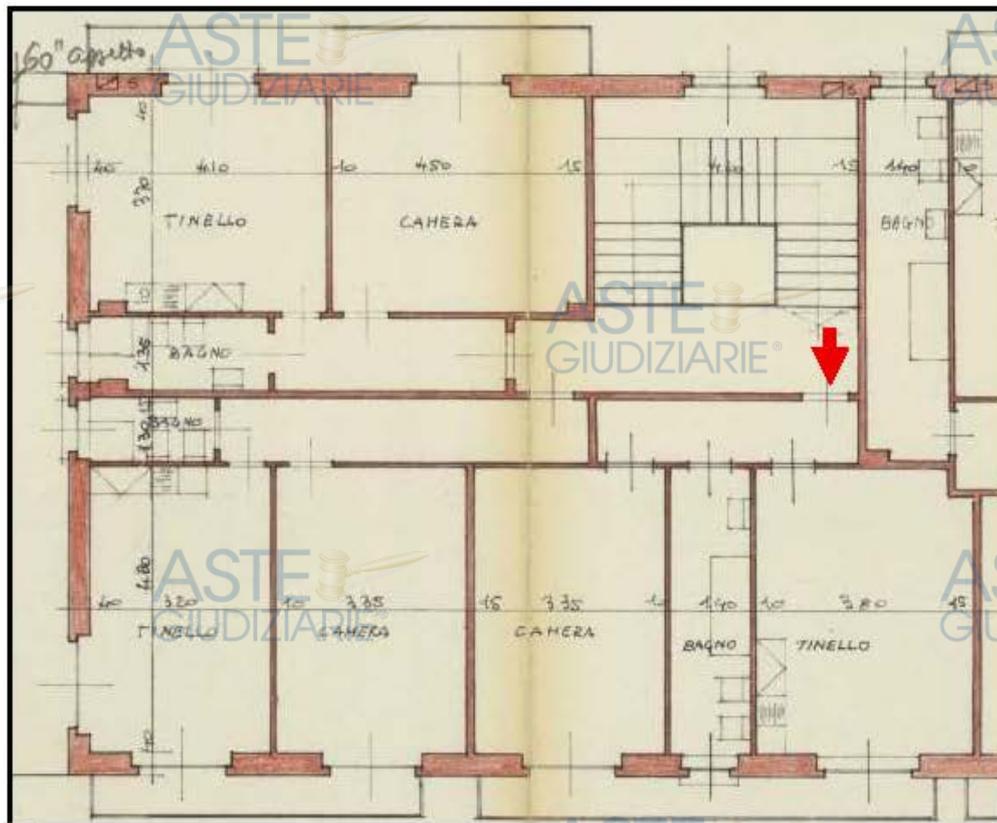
Estratto planimetria piano progetto Licenza edilizia prot. n. prot. 1968 1 30281
